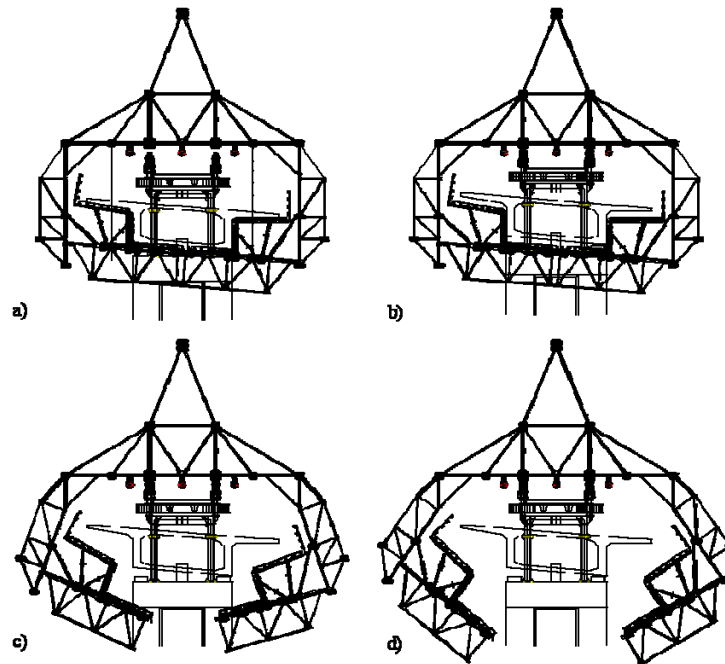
Descida da viga, desmontagem de varões e abertura das estruturas transversais
